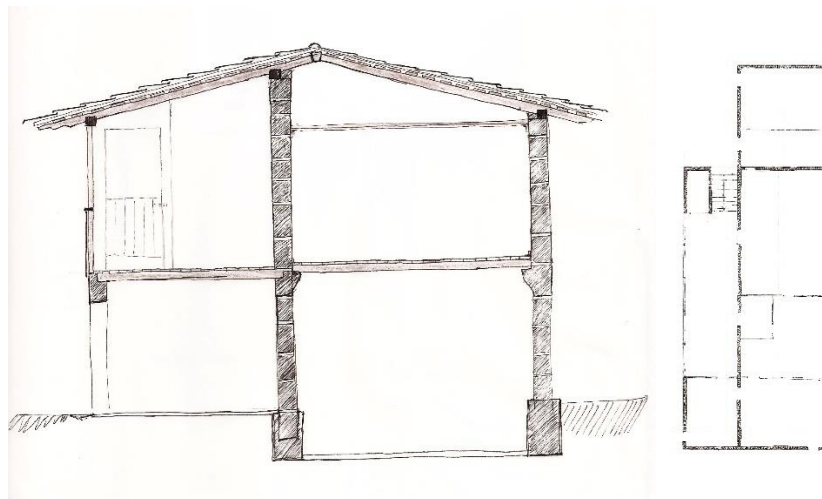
Corte transversal e planta esquemática da casa de Barros
